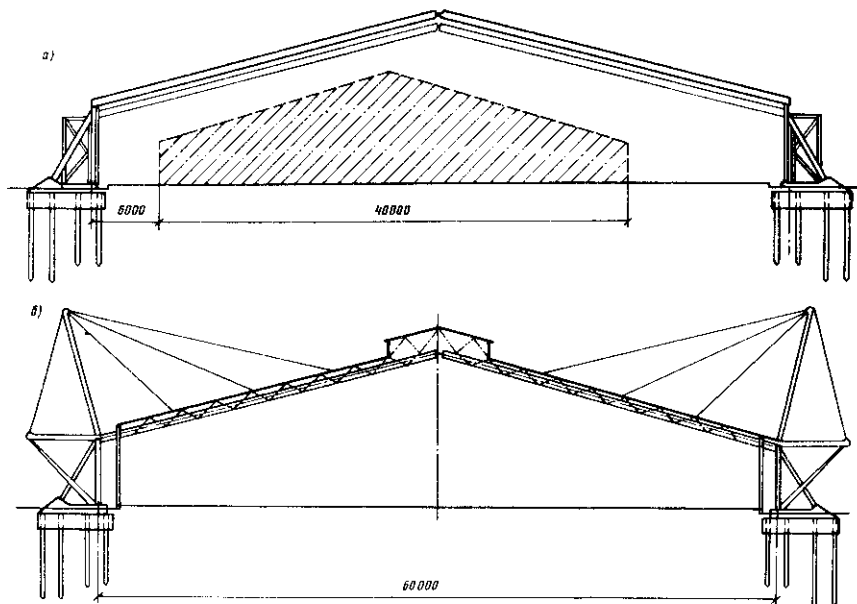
Надвигка вантового покрытия над реконструируемым цехом (Венгрия)
